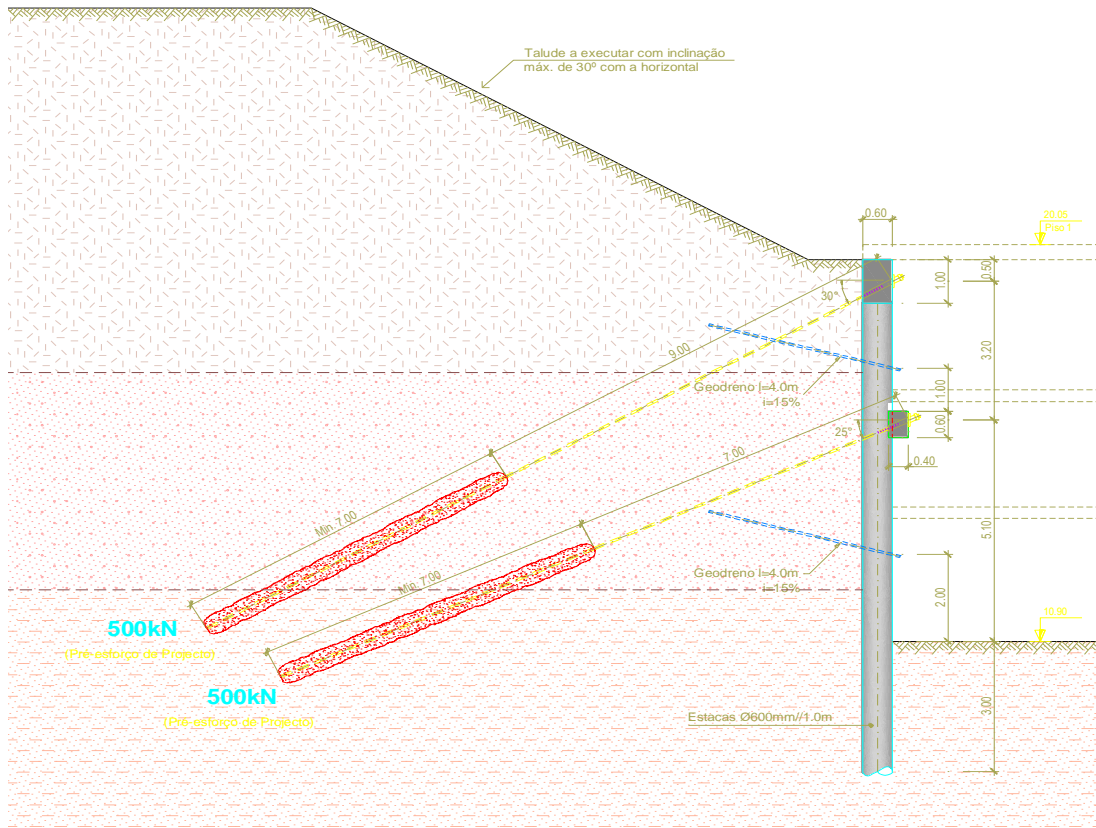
Corte tipo 1: primeiro e segundo níveis de ancoragens e drenos sub-horizontais.
